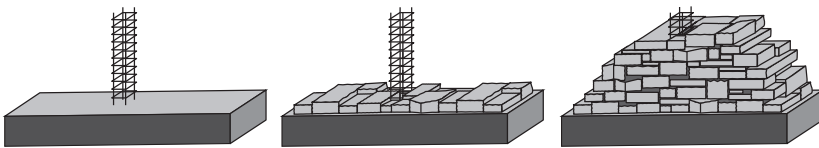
Каменная кладка с перевязкой элементов стен и столбиков
